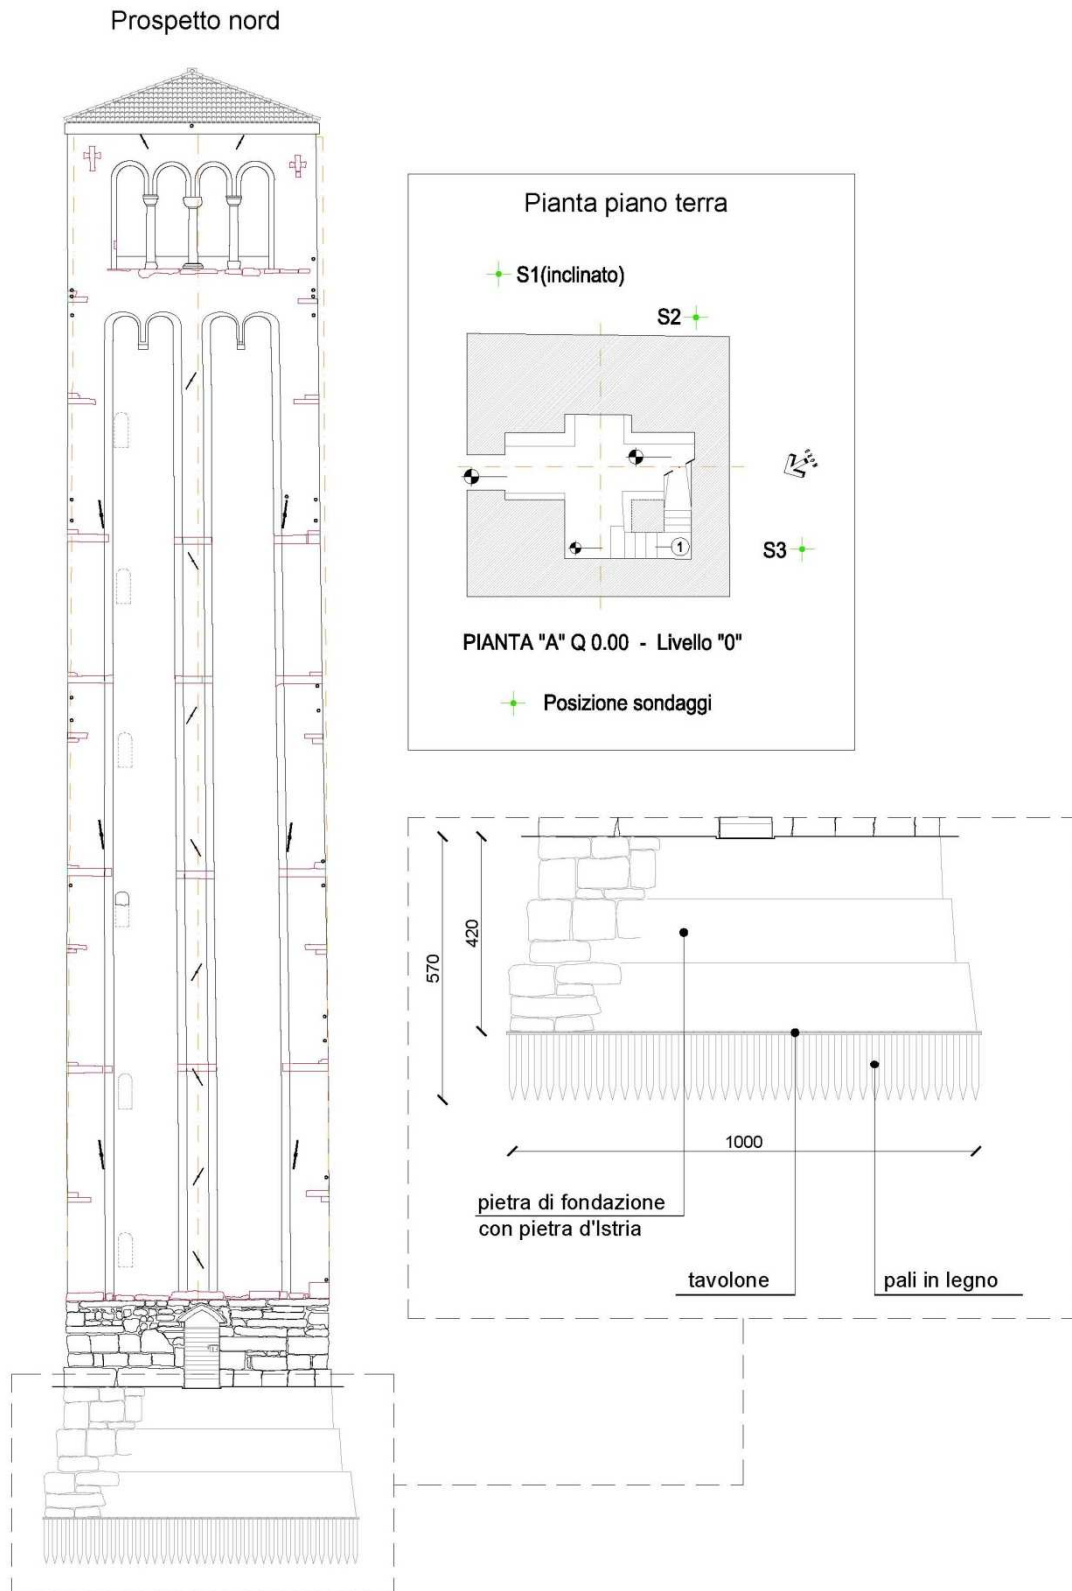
e Figura 9 – Pianta e prospetto campanile Santa Maria Assunta Isola di Torcello - Venezia
